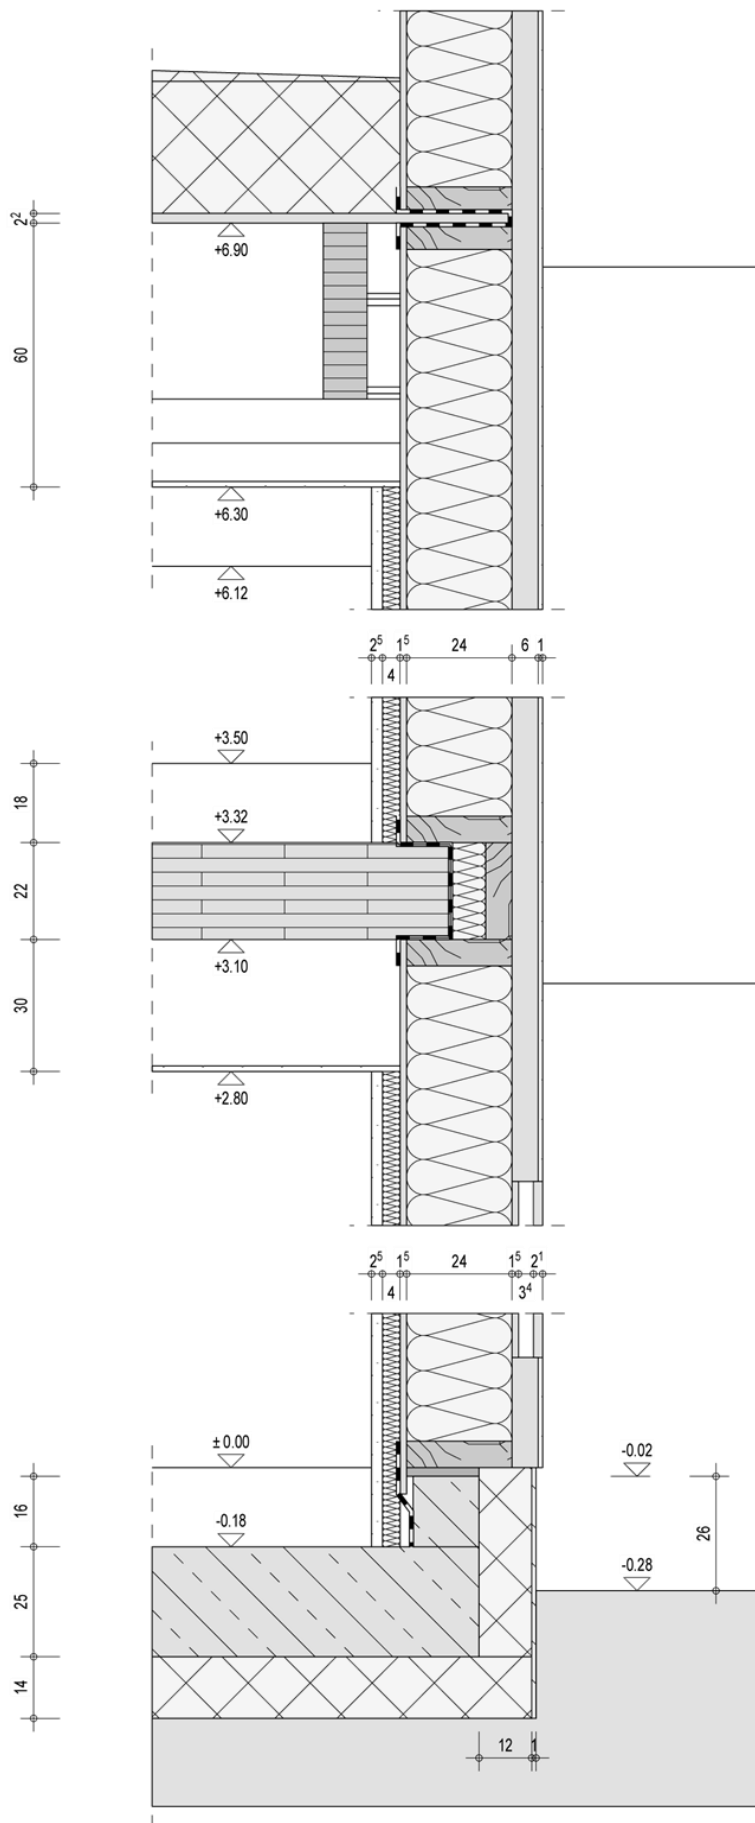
Fassadenschnitt (Stand: Genehmigungsplanung, Details wurden in der Werkplanung geringfügig angepasst)
